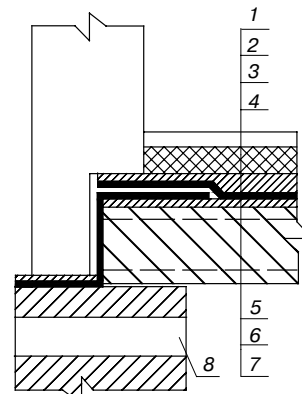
Сочетание сплошного барьера с мембраной: 1 – монолитный железобетон; 2 – защитный слой; 3 – рулонный гидроизоляционный материал; 4 – выравнивающая стяжка; 5 – подготовка из тощего бетона; 6 – уплотненный грунт
